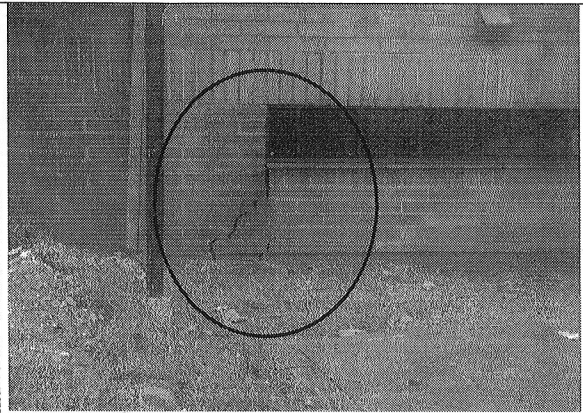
Agrietamiento en el extremo sur del muro de cerramiento.
